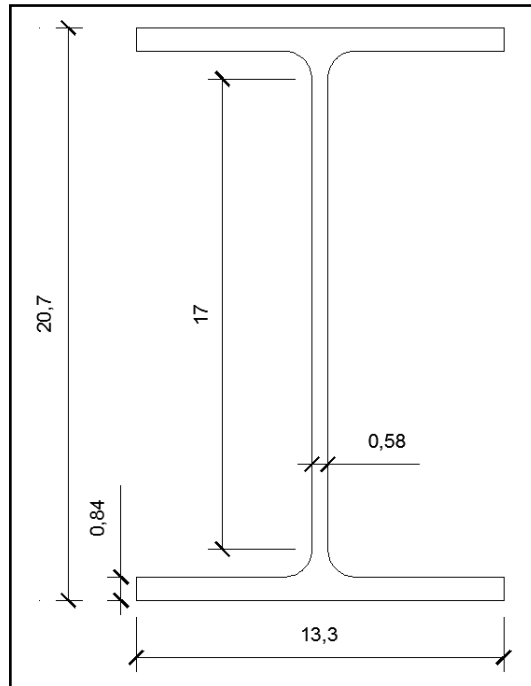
Perfil utilizado nas vigas - W 200 x 26,6 (medidas em cm)
